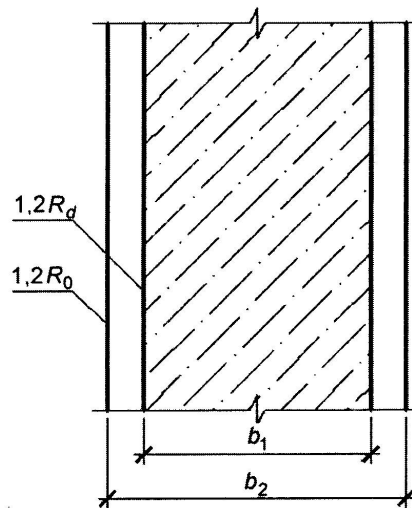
Обмеження тисків під подошвою стрічкових фундаментів
